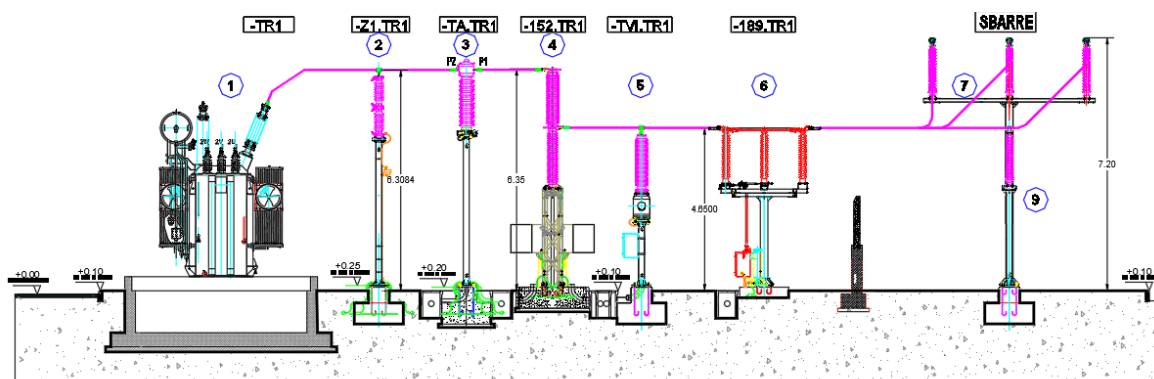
LAYOUT APPARECCHIATURE STAZIONE SSE
